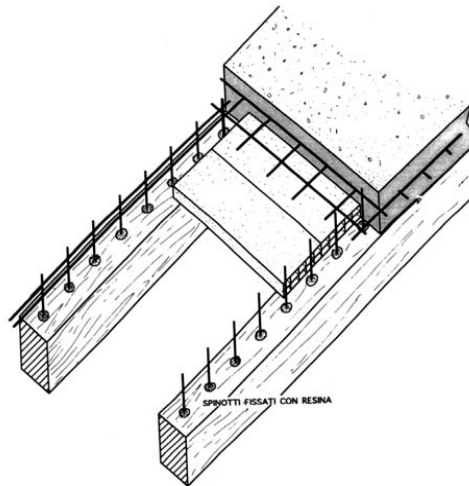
Alessi, Raffagli, Lamborghini (ref. 33)
